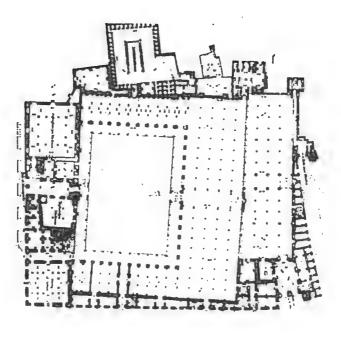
المسقط الأفقي لجامع سامراء الكبير .
